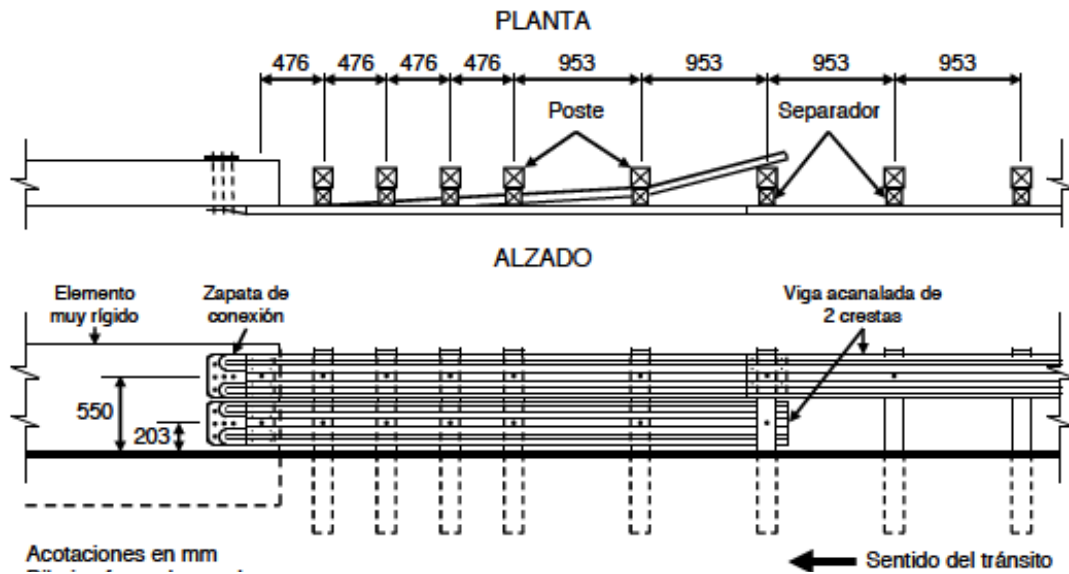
Transición de barrera metálica de doble banda a muro vertical recto
